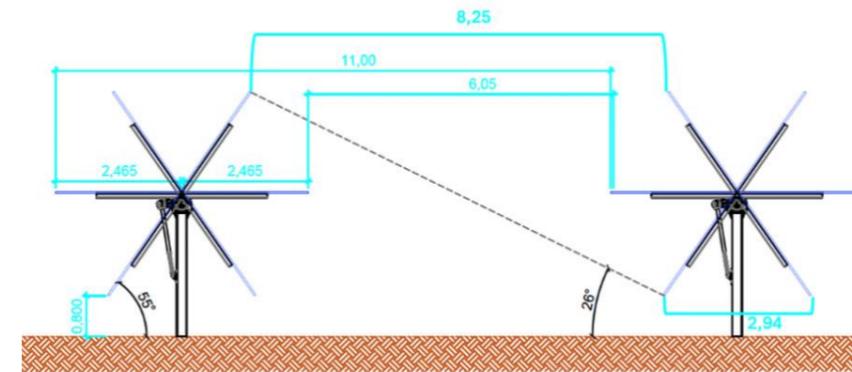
Sezione delle strutture impiegate per il progetto presentato
